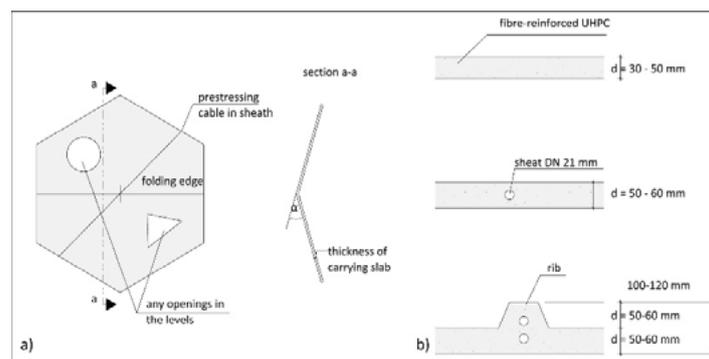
t-USE Baseelement a) Grundriss und Schnitt, b) Querschnittsformen
